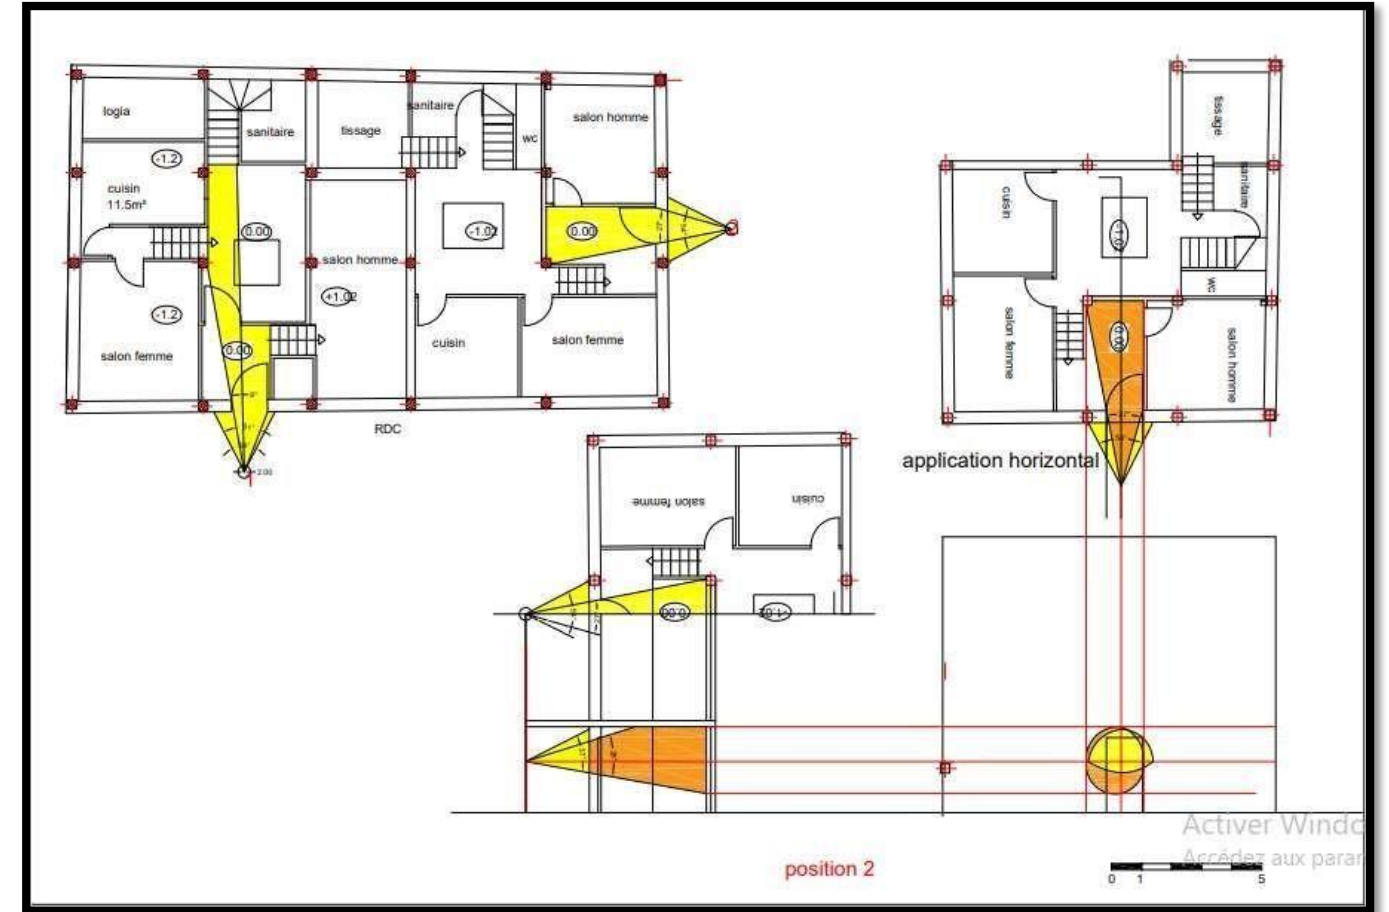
Position 02 , plan : Imbriqué verticalement type 01
